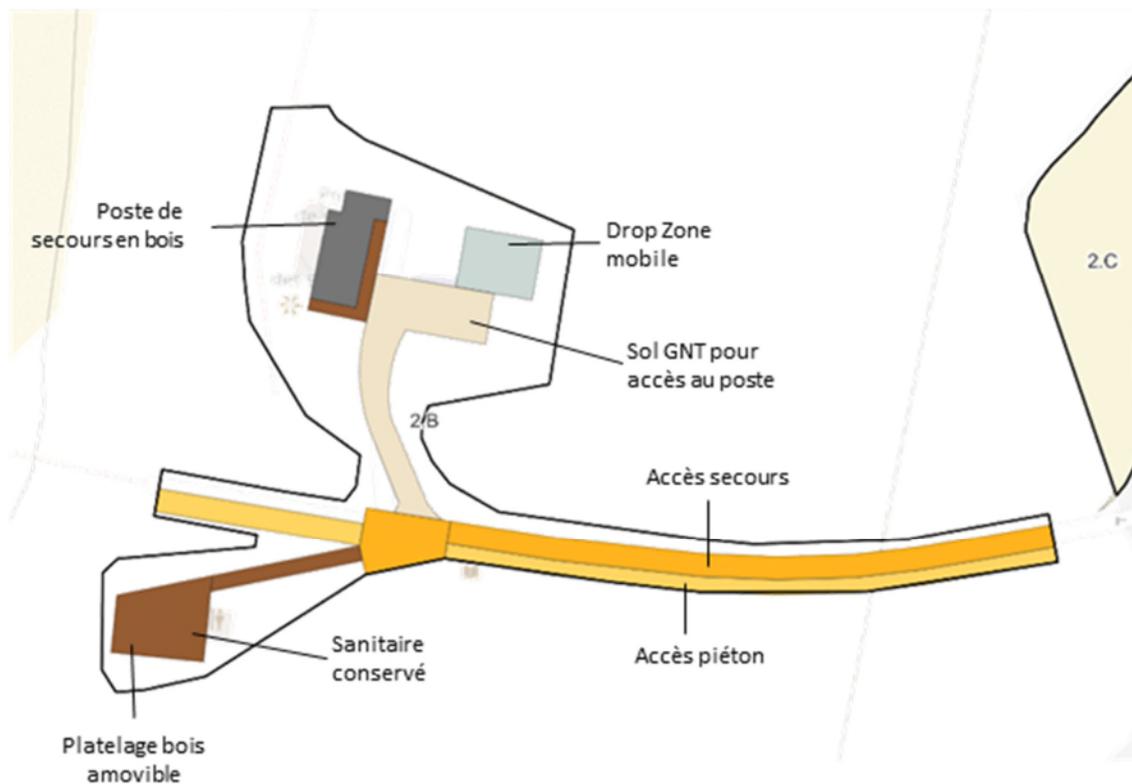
Plans des aménagements projetés au niveau de l'accès plage (D'Une Ville à l'Autre, 2024).
